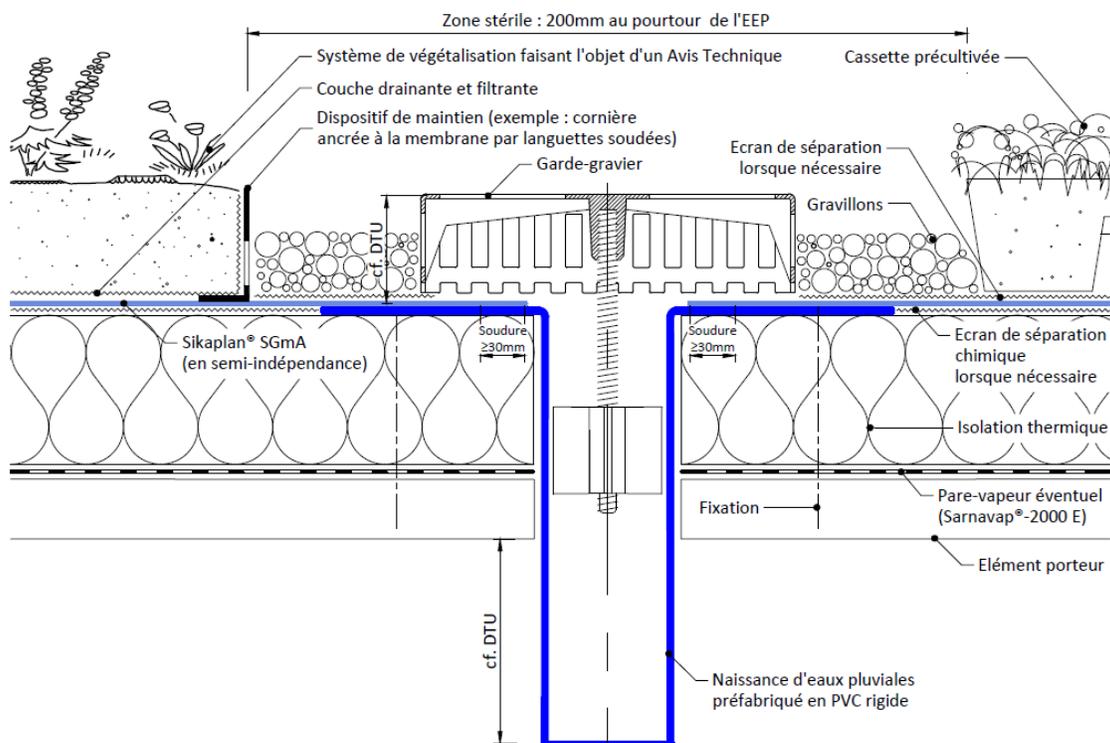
Entrée d'eaux pluviales avec moignon cylindrique préfabriqué en PVC rigide et dispositif par double EEP
